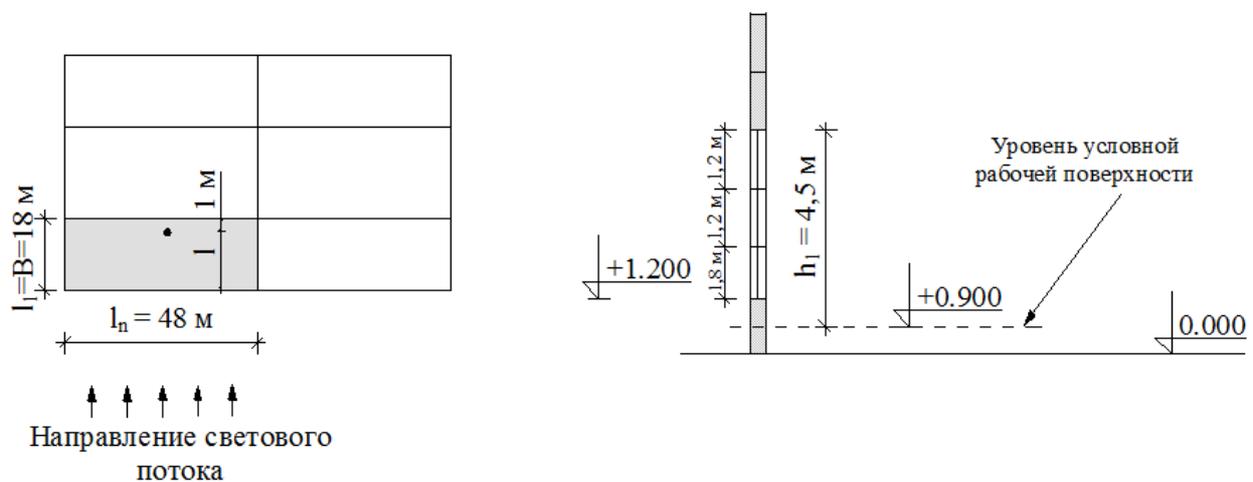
План этажа и фрагмент разреза трехпролетного производственного здания с условными обозначениями
